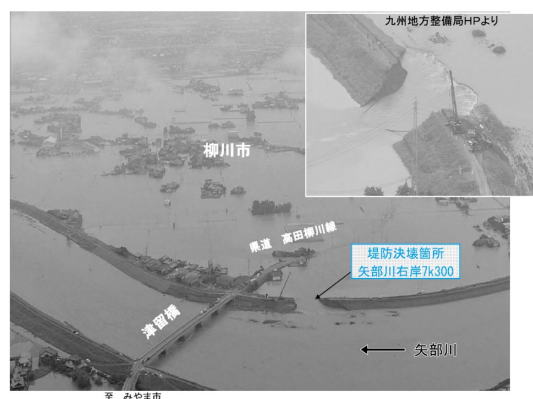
九州北部豪雨の状況 7月14日浸水状況（矢部川水系）
